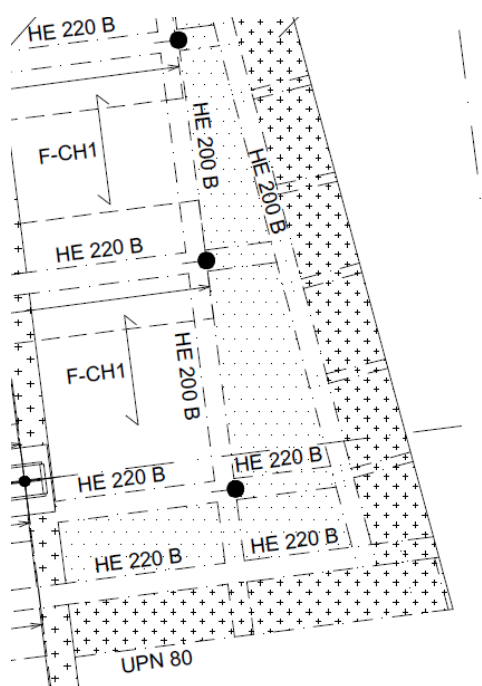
Vista de alero en planta baja. Planos de estructura de proyecto.
